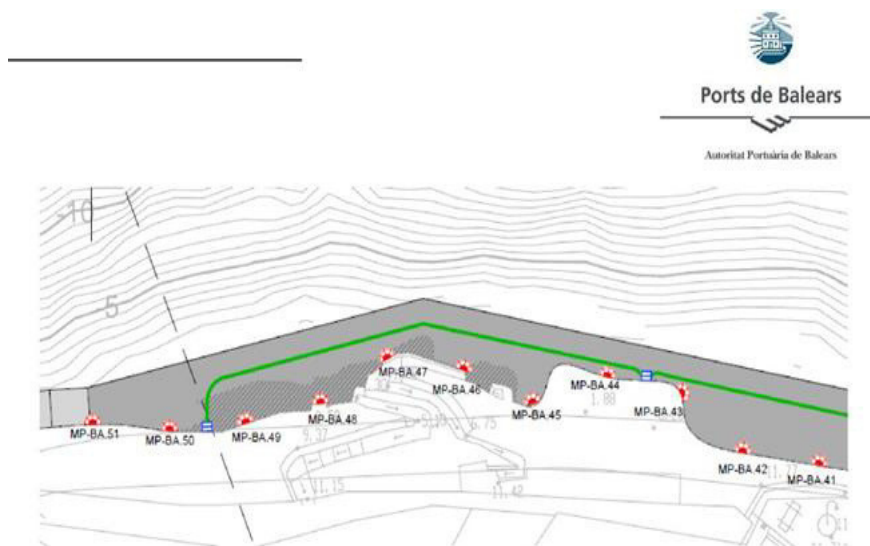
Propuesta de instalación eléctrica en planta en el tramo de muelle de gravedad.
